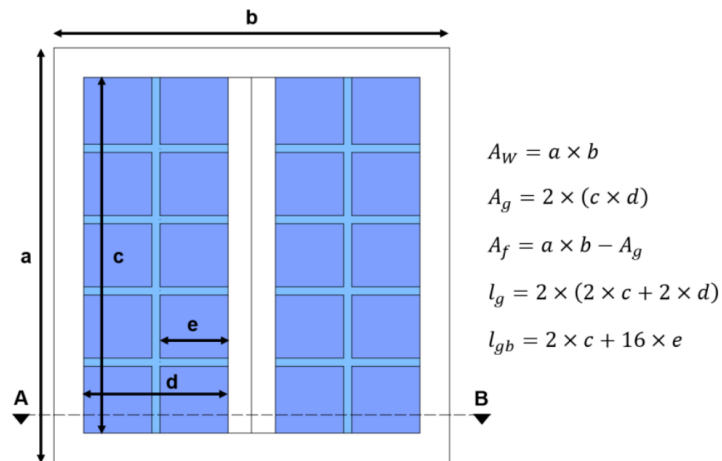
Parâmetros dimensionais de um vão envidraçado (vista de alçado). [8]
